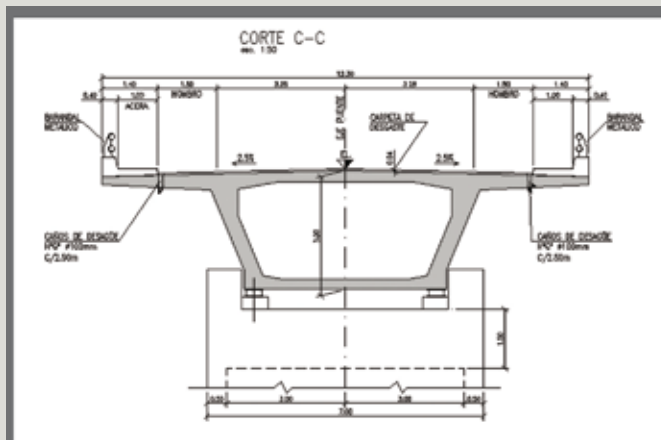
Sección transversal tableros Nombre de Jesús y Nuevo Edén de San Juan
